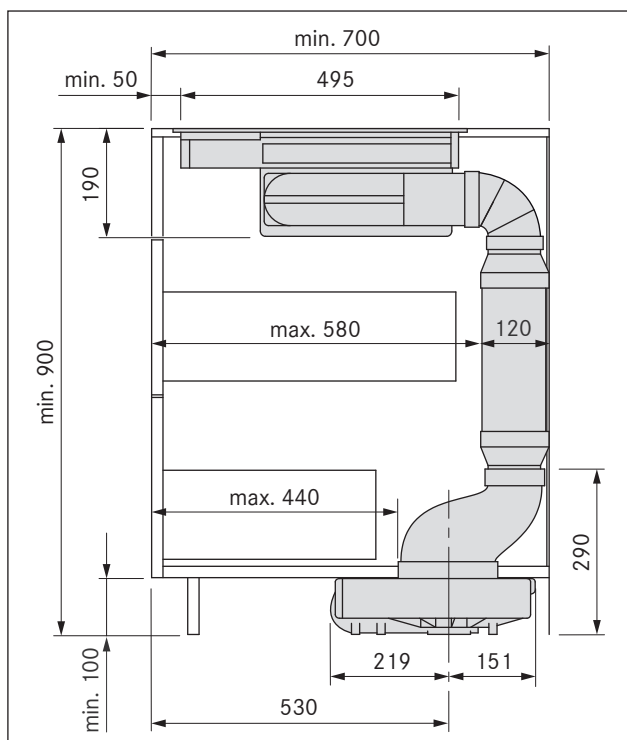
Dimensões de montagem do aparelho com silenciador plano USDF num armário com 700 mm de profundidade
